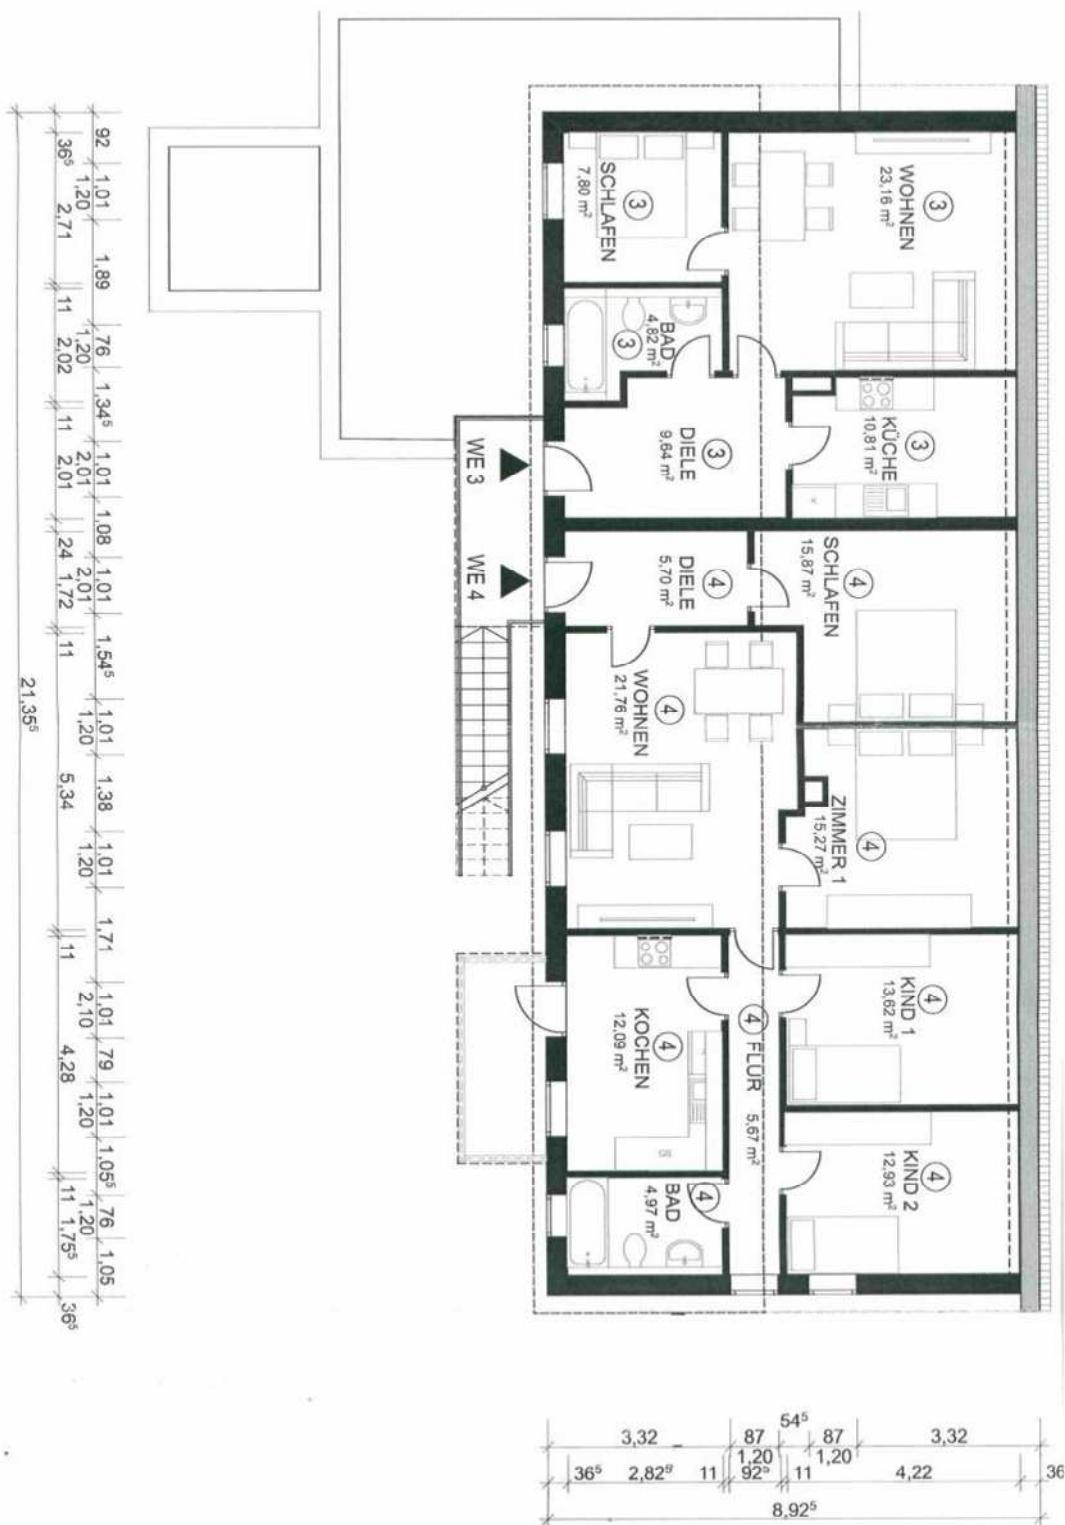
Grundrissplan DG (vom Eigentümer)
